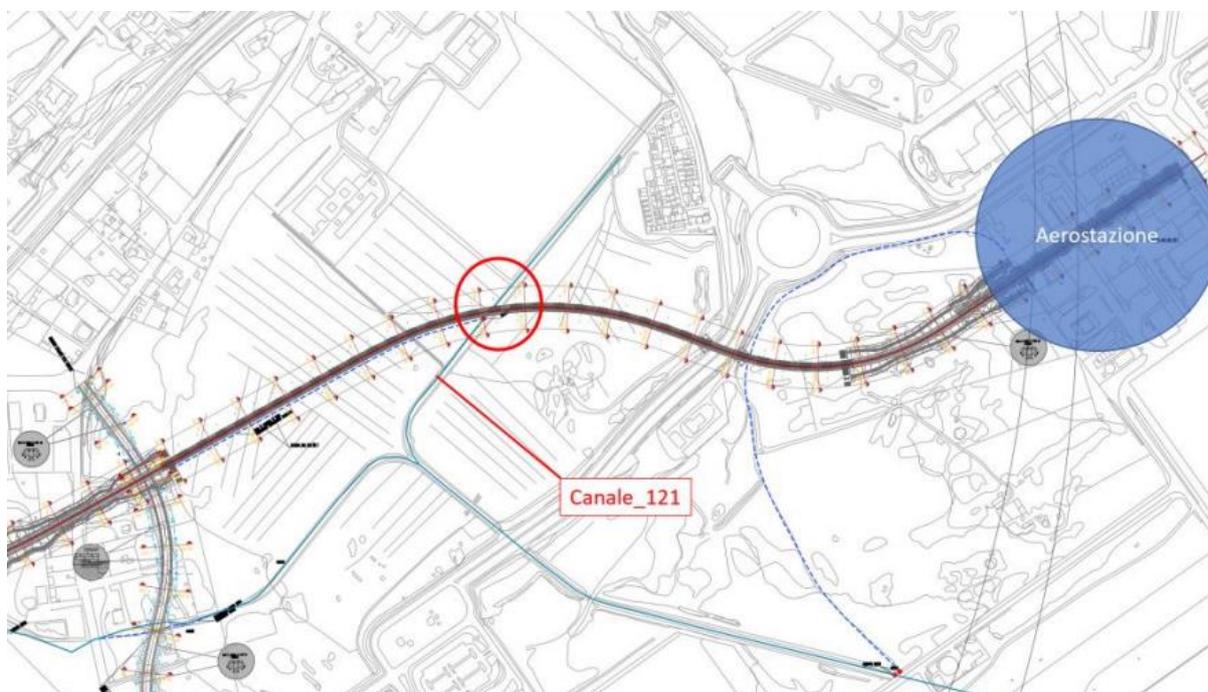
Inquadramento planimetrico interferenza con canale 121
